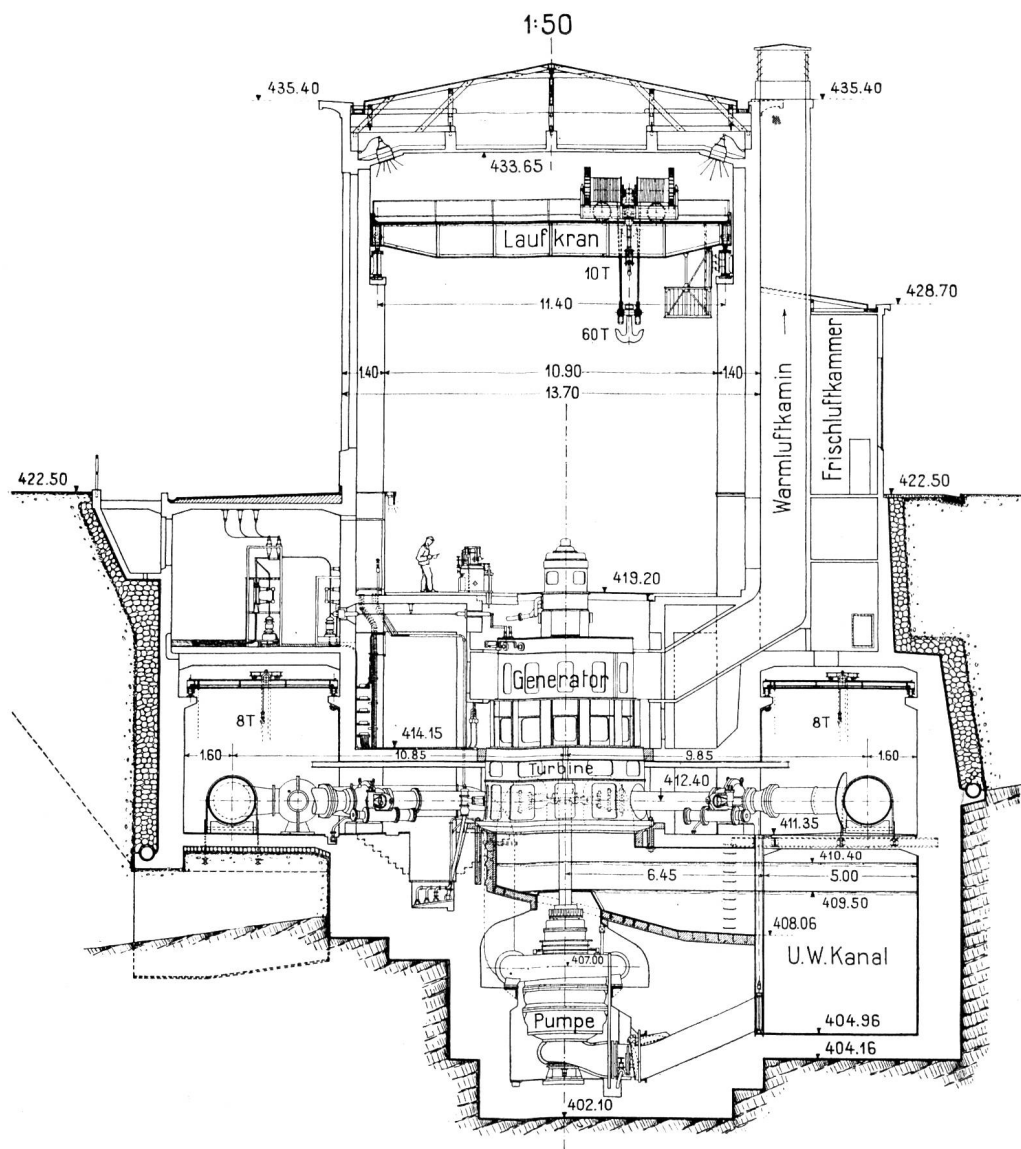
Etzelwerk Maschinenhaus. Querschnitt durch die Turbinen-Pumpengruppe. Maßstab 1:250
